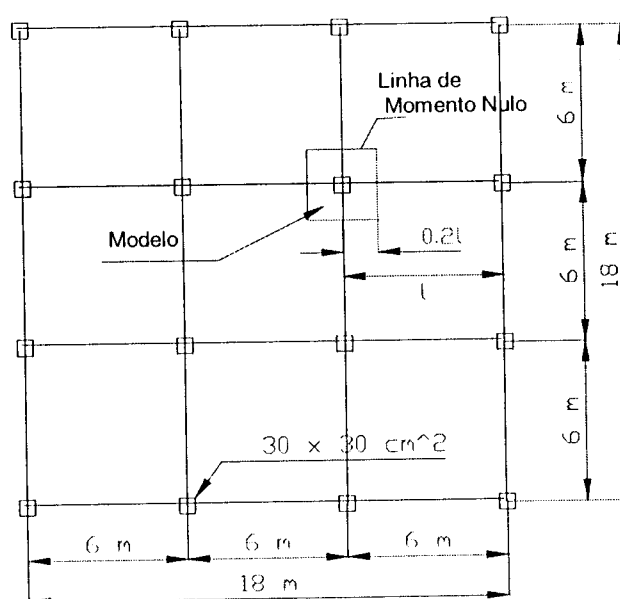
Planta típica de um pavimento de lajes-cogumelo.
